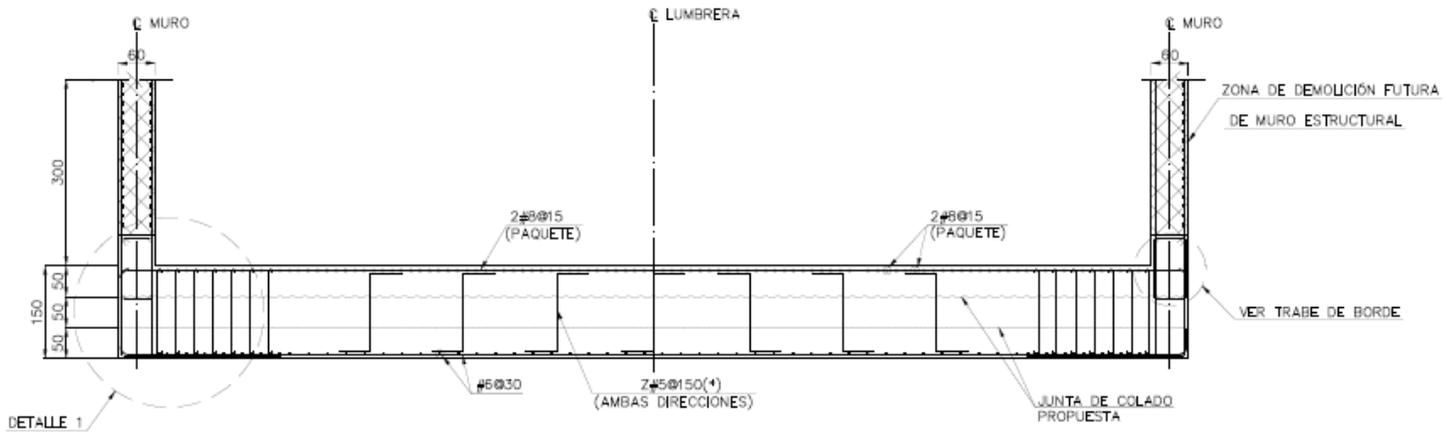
Perfil de losa de fondo, trabe de borde para portales y zona de demolición futura de muro estructural.
